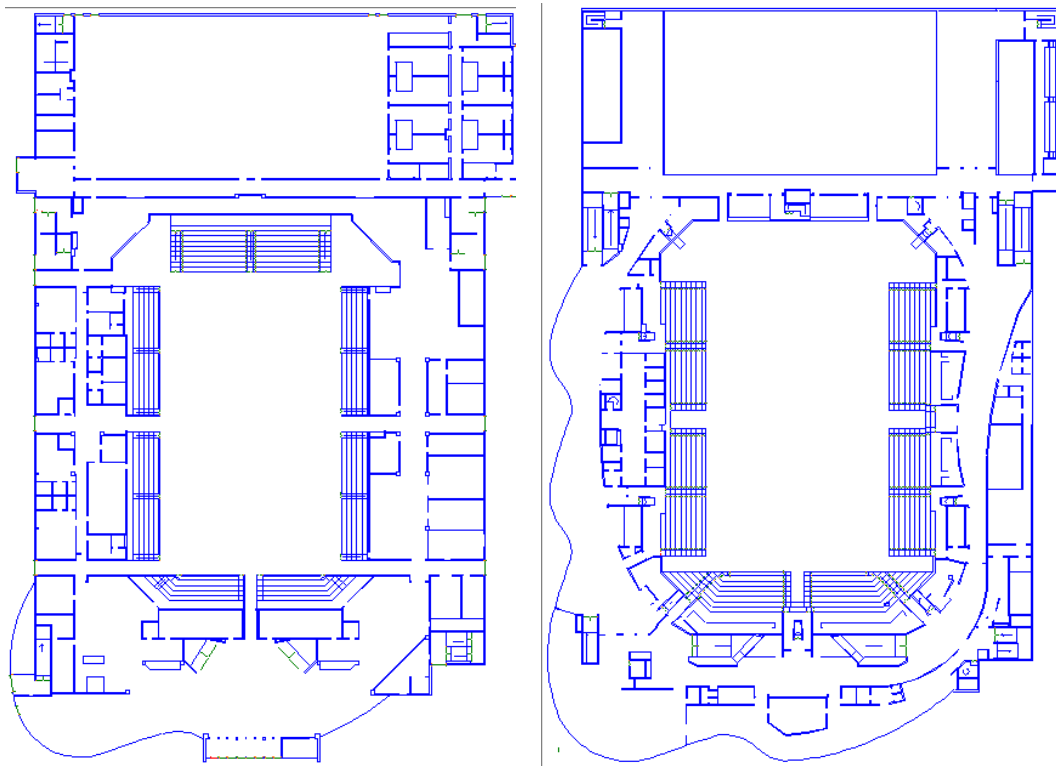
Simuleringens utseende efter 360 sekunder. Till vänster syns plan 1 och till höger plan 2.
